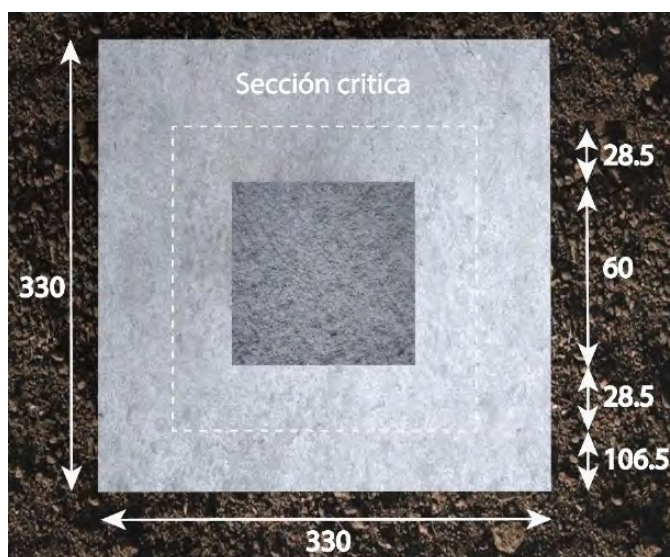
Sección crítica de la zapata tomada a $d/2$
